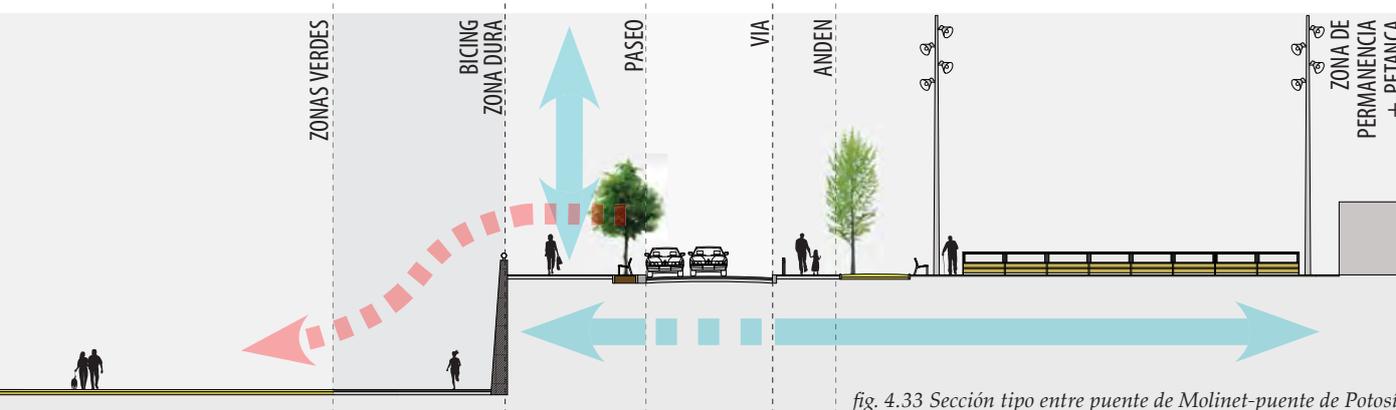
Sección tipo entre puente de Molinet-puente de Potosí
